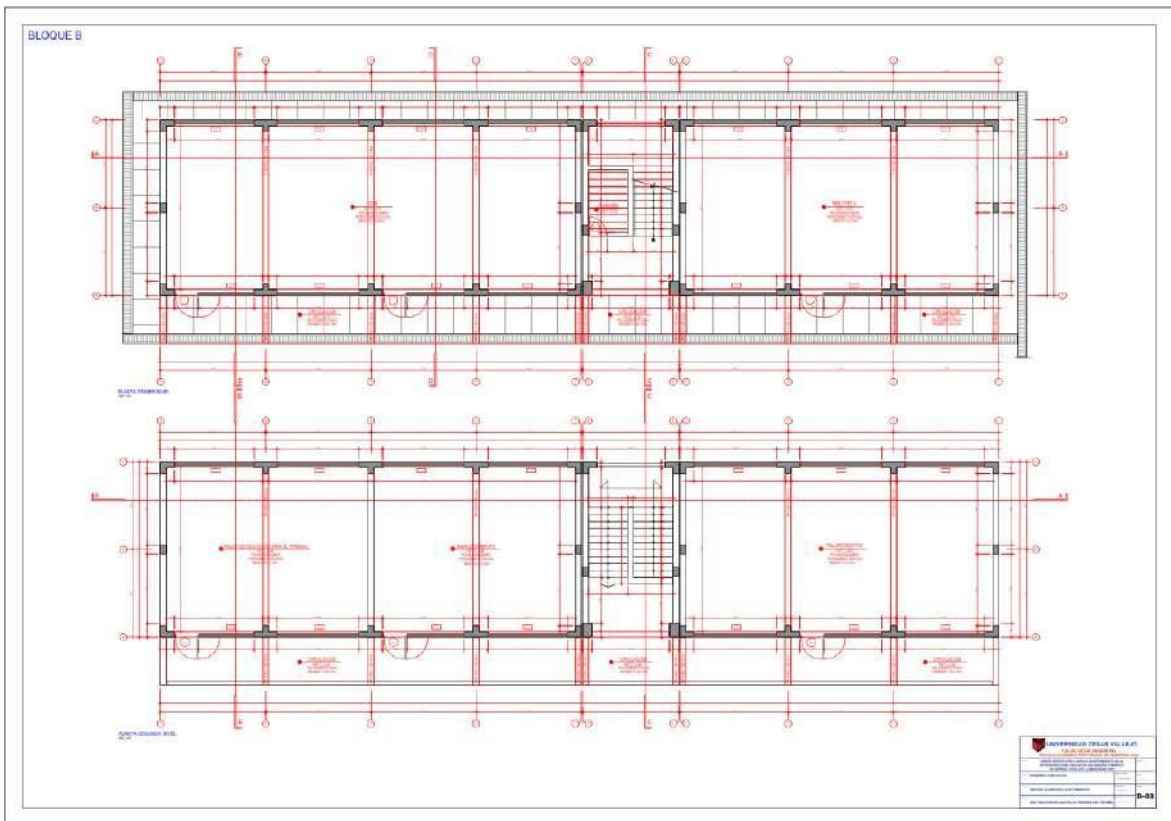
Plano D-03: Desarrollo Bloque B, 17-10-2021.
